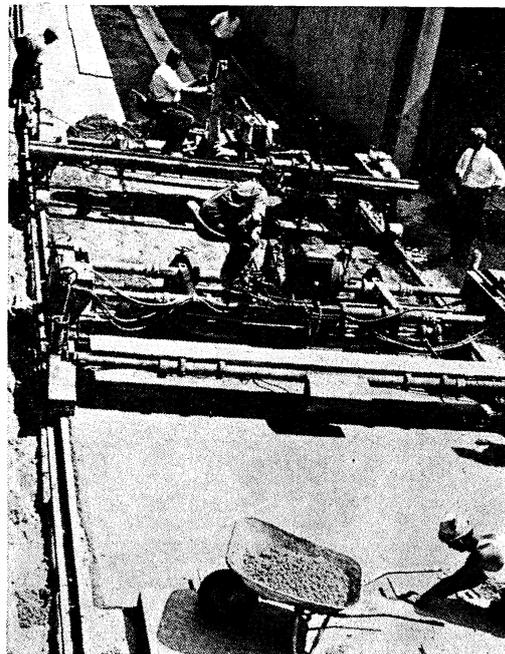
Construcción de carreteras. Colocación del hormigón ligero de Styropor.
